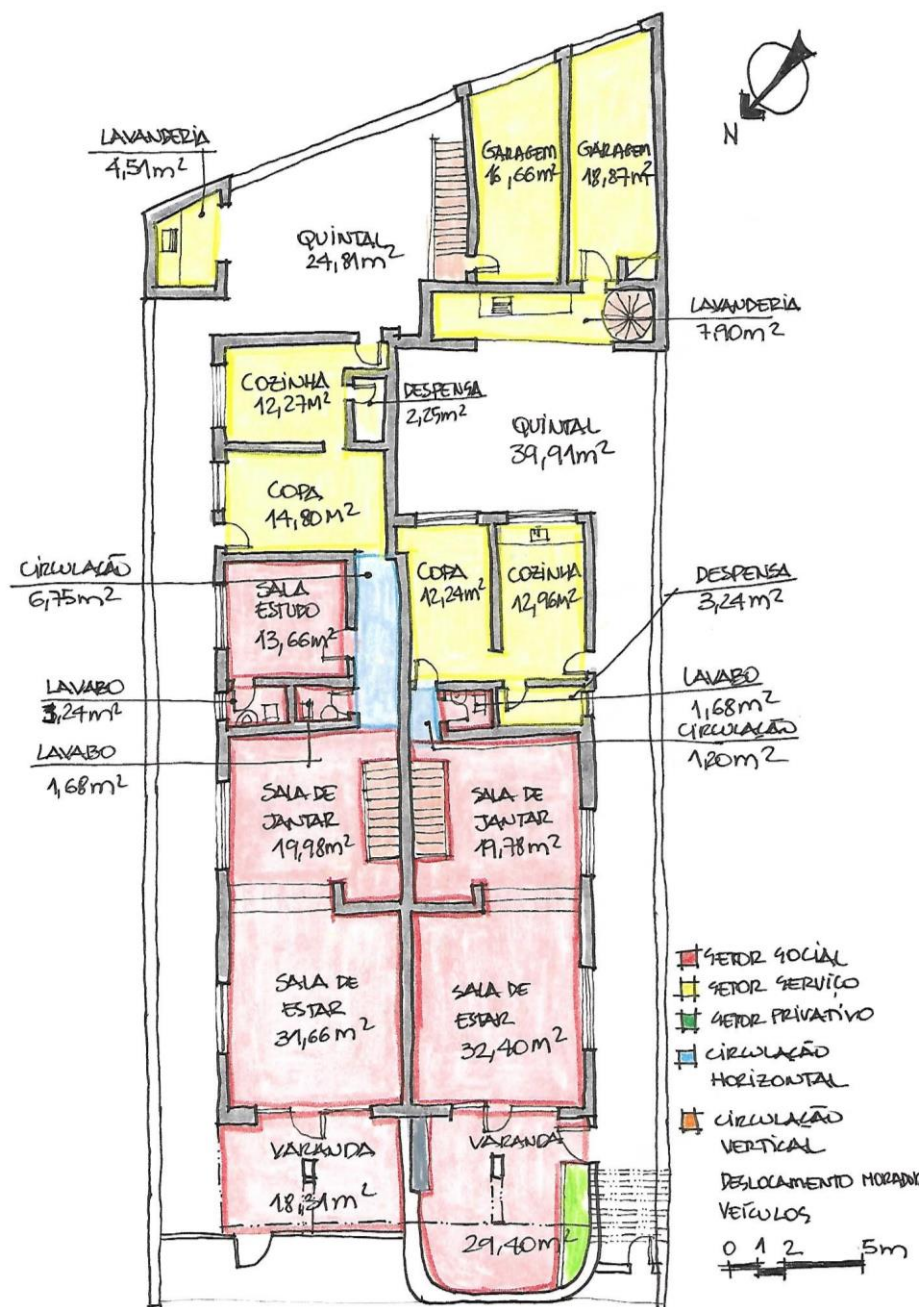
Planta do pavimento térreo da Residência nº 524. Fonte: autora, 2018.
